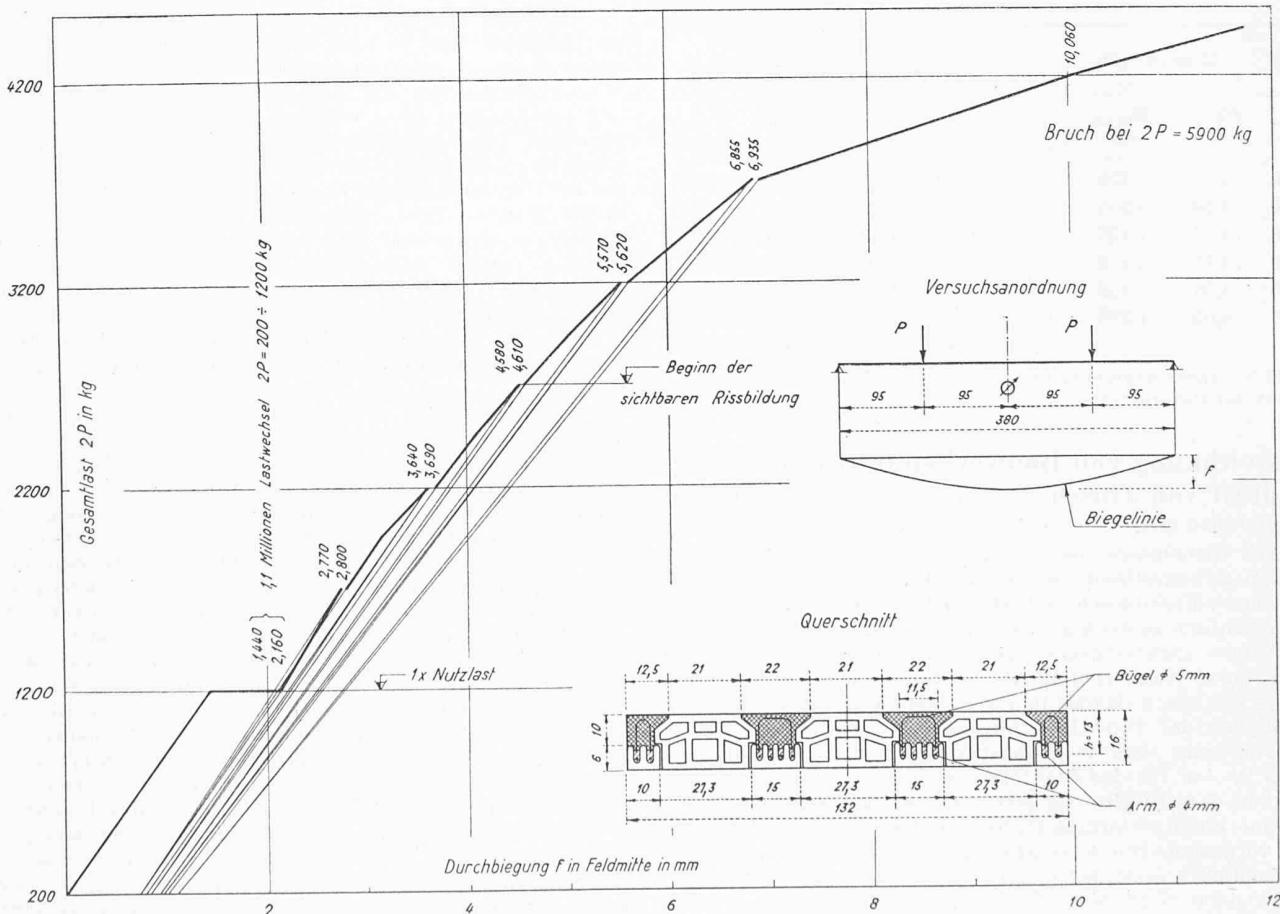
Durchbiegungen in Feldmitte einer Stahltondecke
